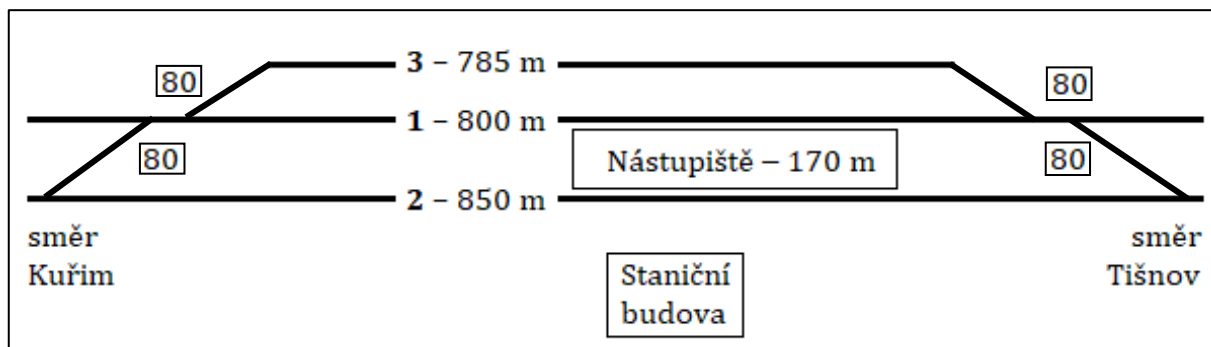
Zjednodušený plán navržené stanice Čebín – varianta A Zdroj: (autor)
